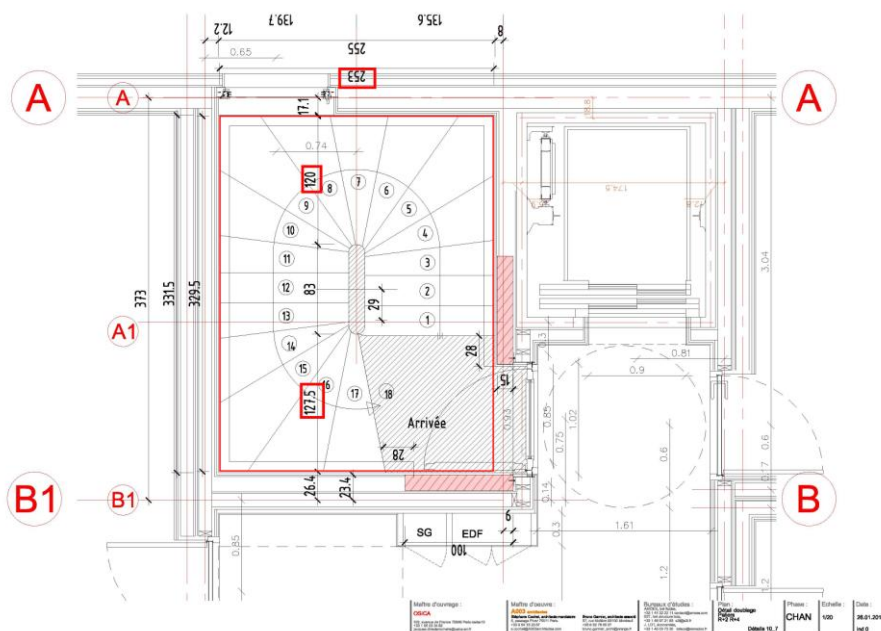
plan d'intégration de l'escalier préfabriqué dans ossature bois
